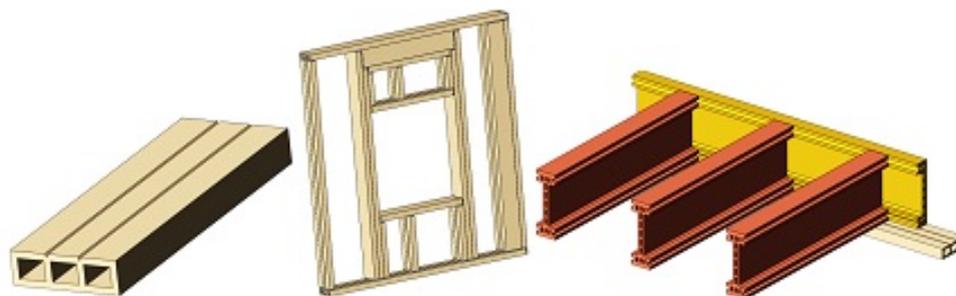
Доска, стеновая панель и конструкция перекрытия
